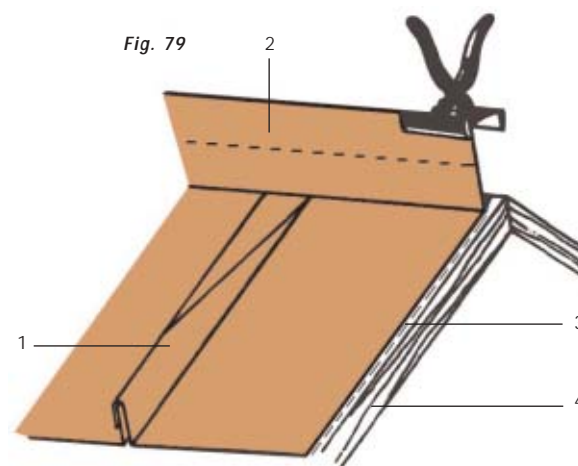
Detalhes construtivos - união das juntas elevadas com a cumeeira executada com caibro- Continuação.
